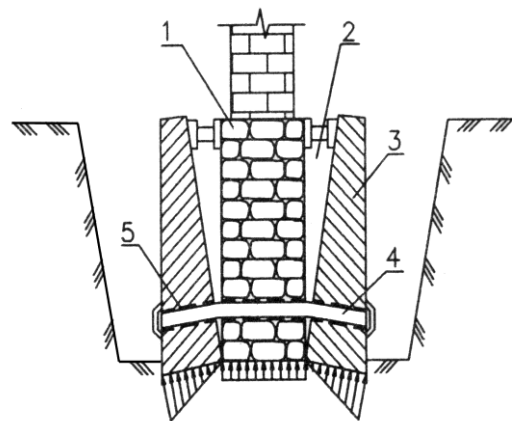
Підсилення фундаментів додатковими блоками, обжимаються ґрунти основи за їхнього повороту: 1 – існуючий фундамент; 2 – щілина, що утворюється під час повороту блоків; 3 – залізобетонний блок; 4 – анкерне кріплення; 5 – отвори для анкерів
